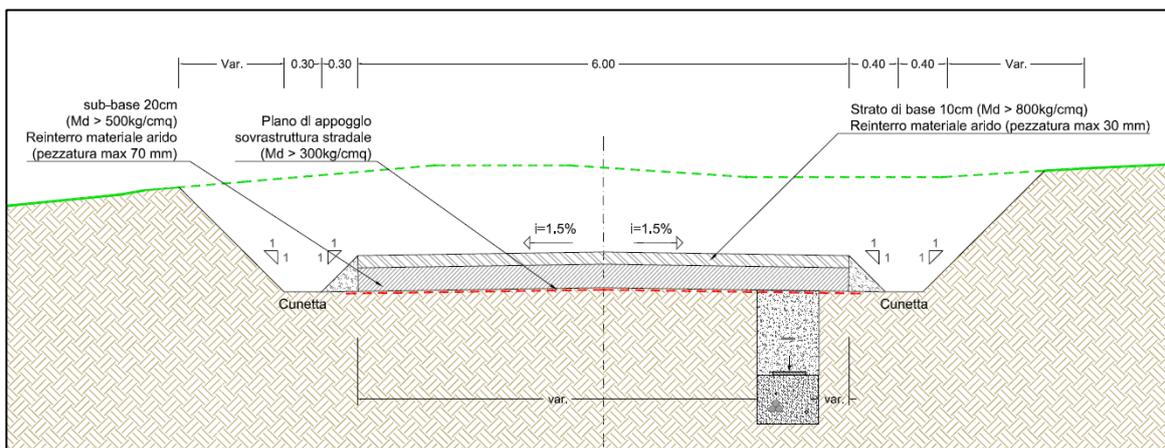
Sezione stradale tipica in rettilineo con cavidotto.
